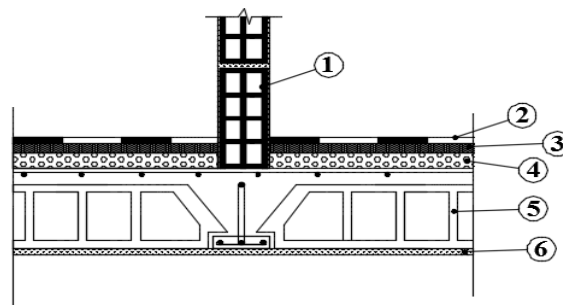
Coupe transversale au niveau de plancher étage courant.
